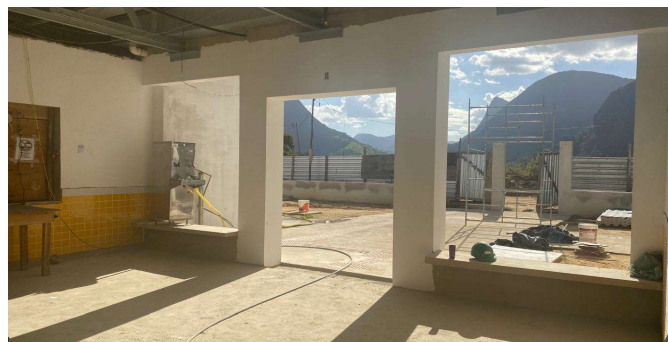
APLICAÇÃO MANUAL DE MASSA ACRÍLICA EM PANOS DE FACHADA SEM PRESENÇA DE VÃOS, DE EDIFÍCIOS DE MÚLTIPLOS PAVIMENTOS, DUAS DEMÃOS.
